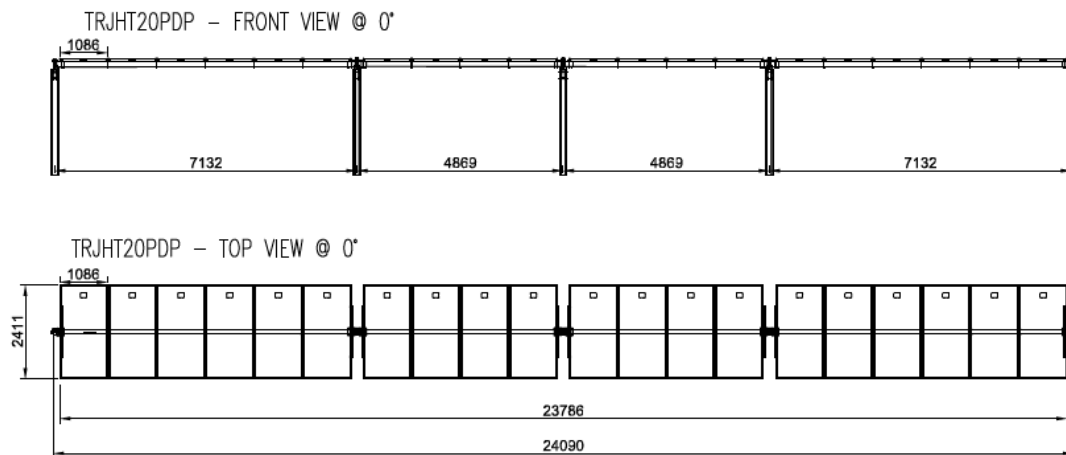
Profilo longitudinale - vista dall'alto tracker e moduli fotovoltaici (Fonte Progetto)
